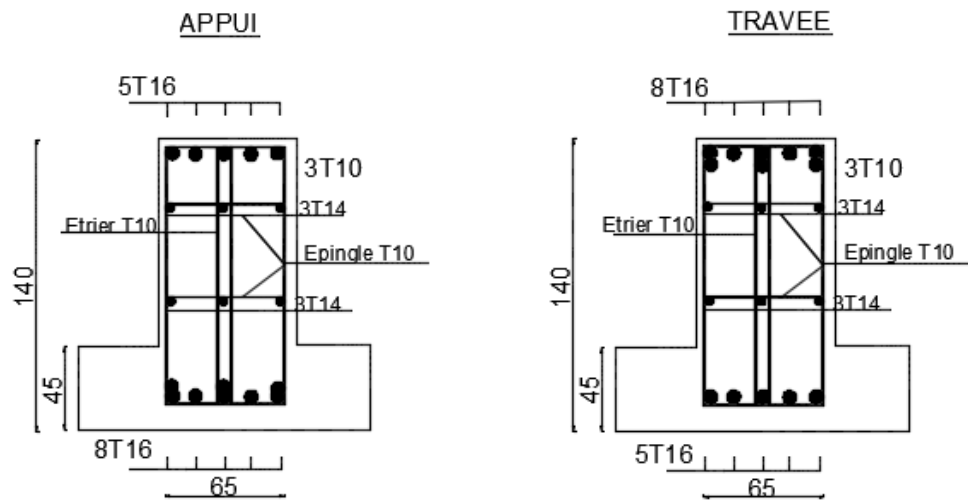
schéma de ferrailage des nervures Y-Y
